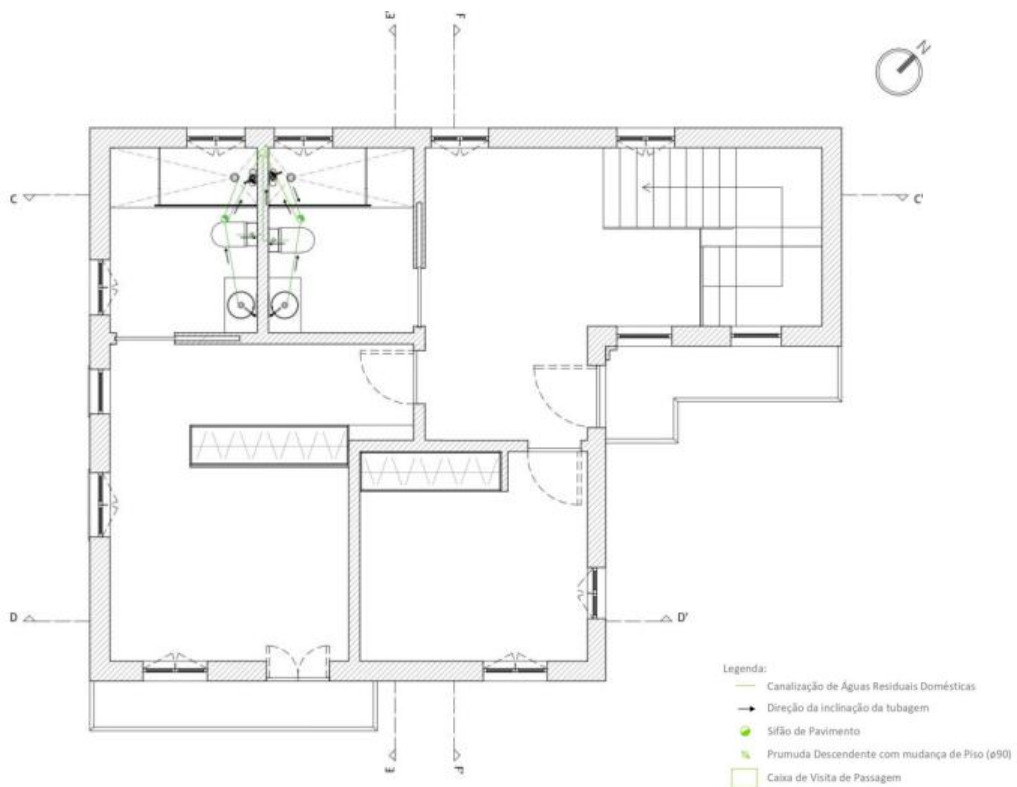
Planta de Esgotos, Piso 1. Fonte: Autor
